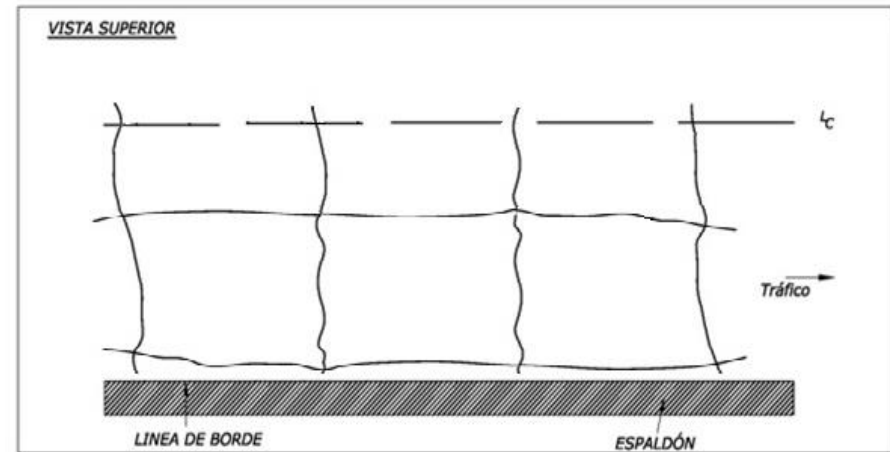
Agrietamiento por Reflejo de Juntas – Pavimento Flexible
